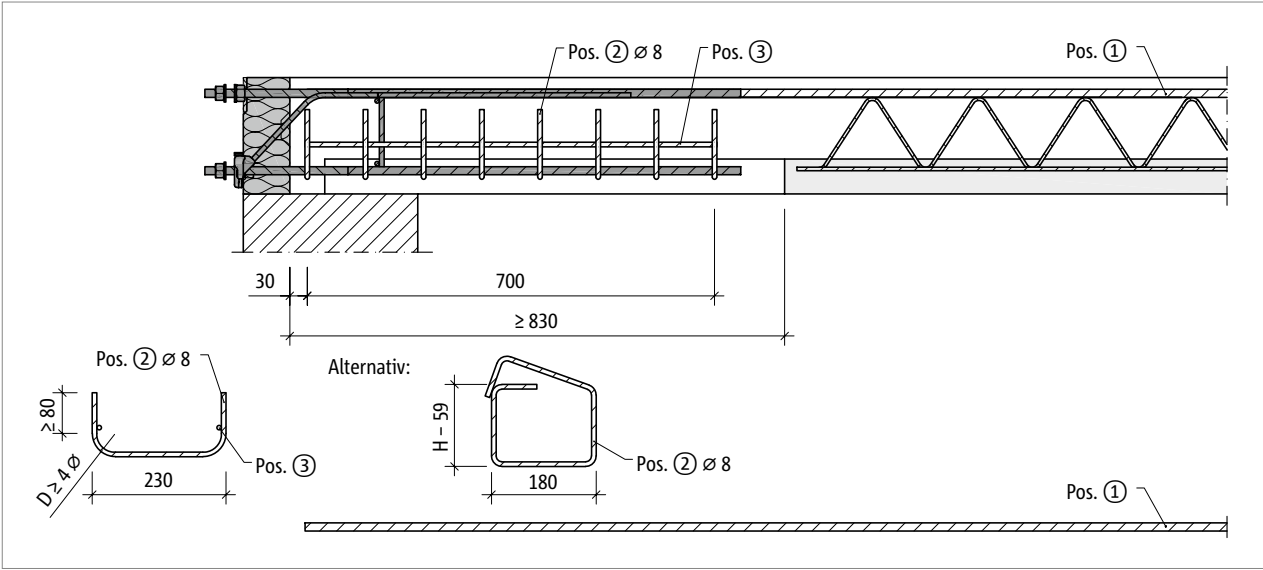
Schöck Isokorb® T Typ SKP-MM1-VV1: Bauseitige Bewehrung bei Halbfertigteilbauweise, Schnitt. Bügelvarianten als konstruktive Querbewehrung in der unteren Deckenbewehrung.
